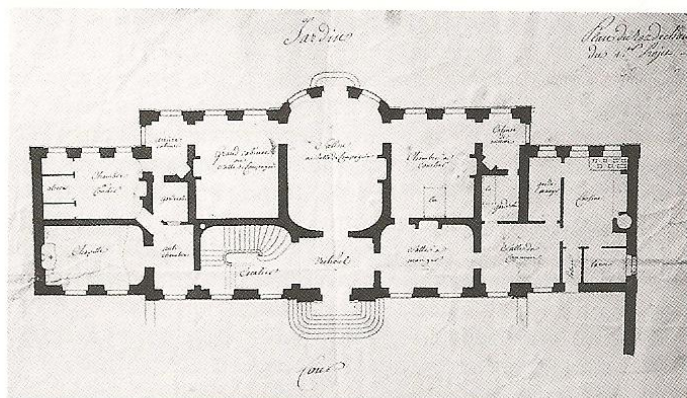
Mansart de Sagonne, Plan au rez-de-chaussée du premier projet pour le château, 1753 ? (archives du château).
